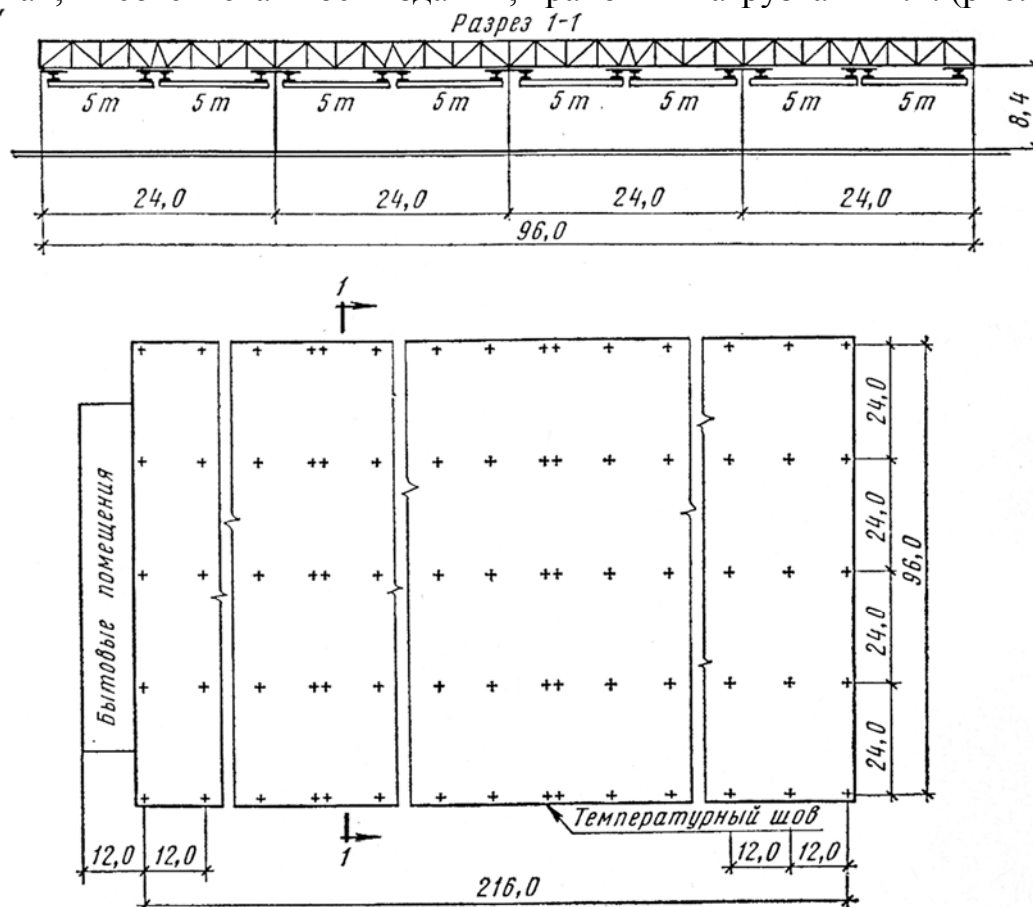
Габаритная схема одноэтажного промышленного здания [37]
